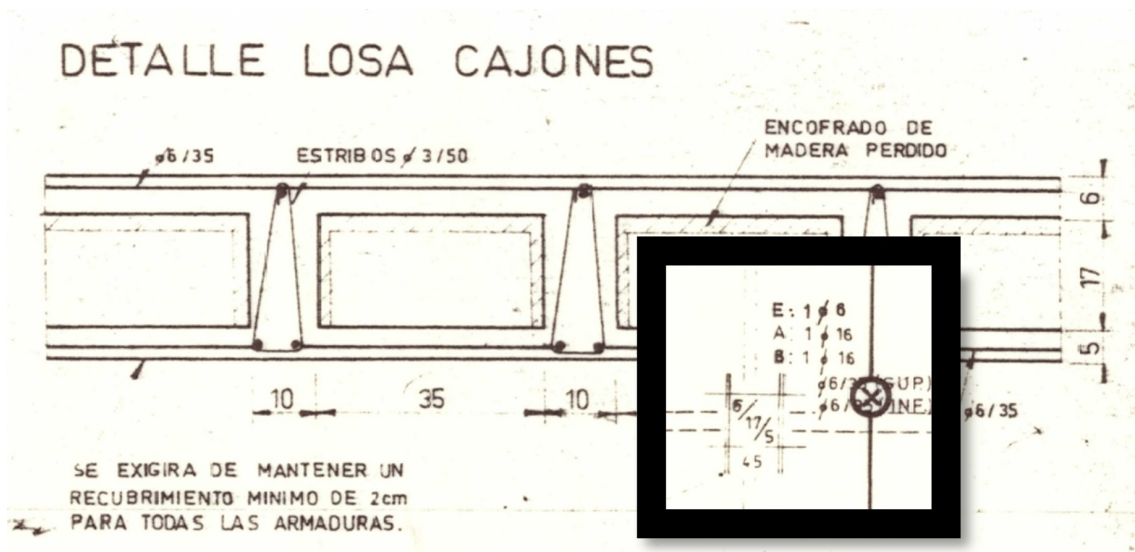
Detalle de sección transversal de losa, donde se observa la cuantía necesaria. (Fuente: Planos de estructura)
